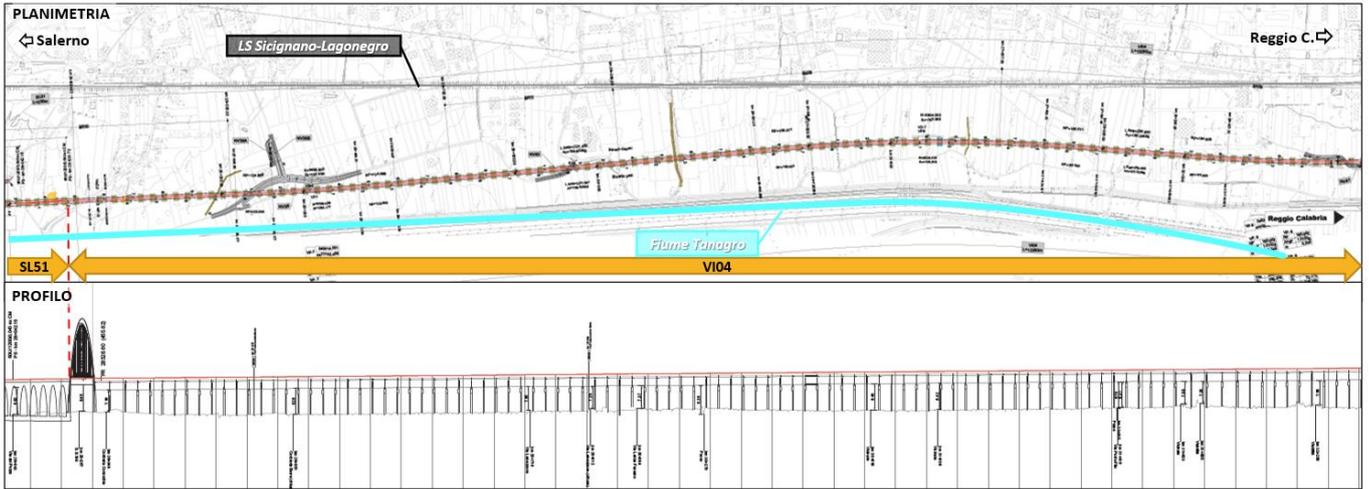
Planopprofilo di progetto da km 28+266 a km 32+300
